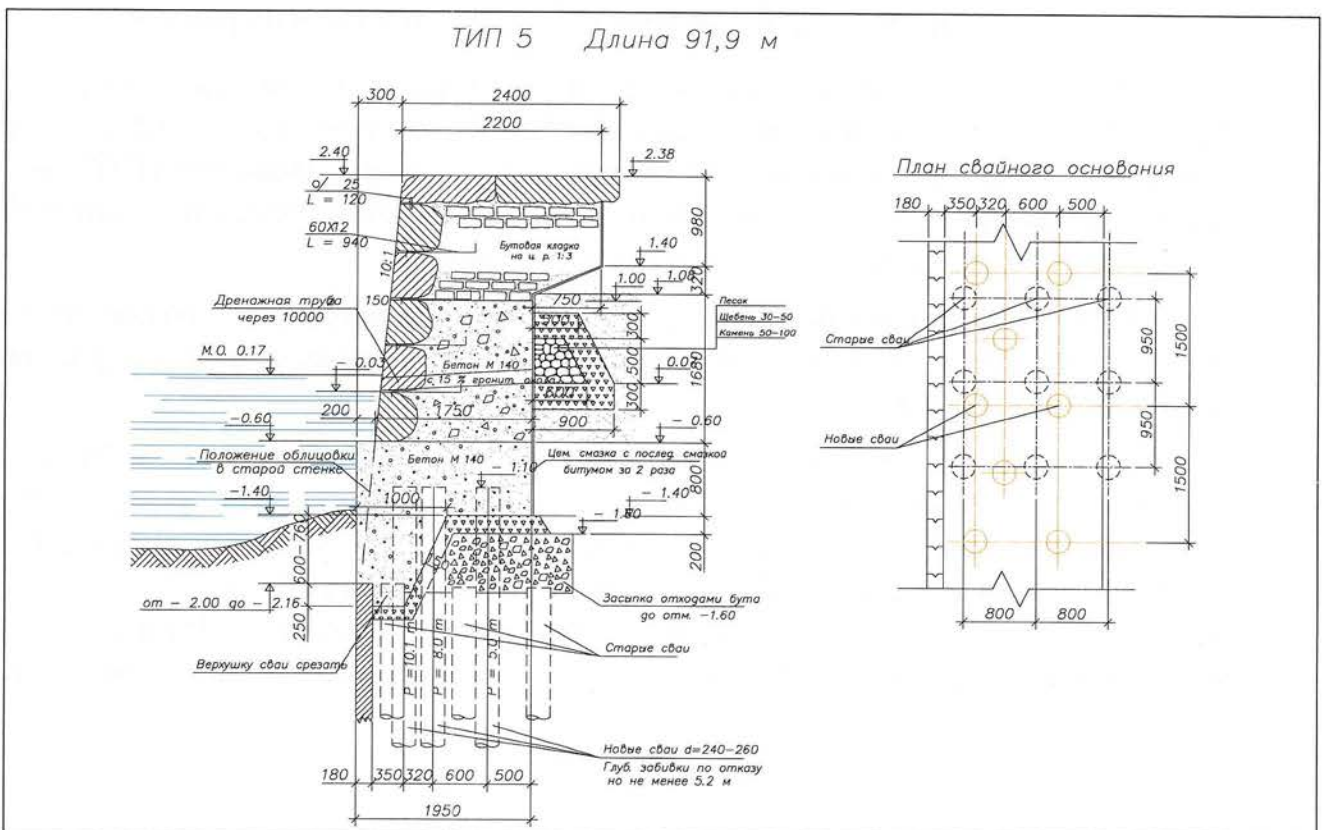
Поперечное сечение стенки набережной тип 5 средний участок
